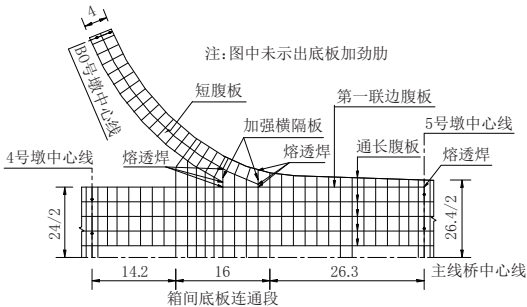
第二跨 1/2 腹板布置平面图(单位:m)
